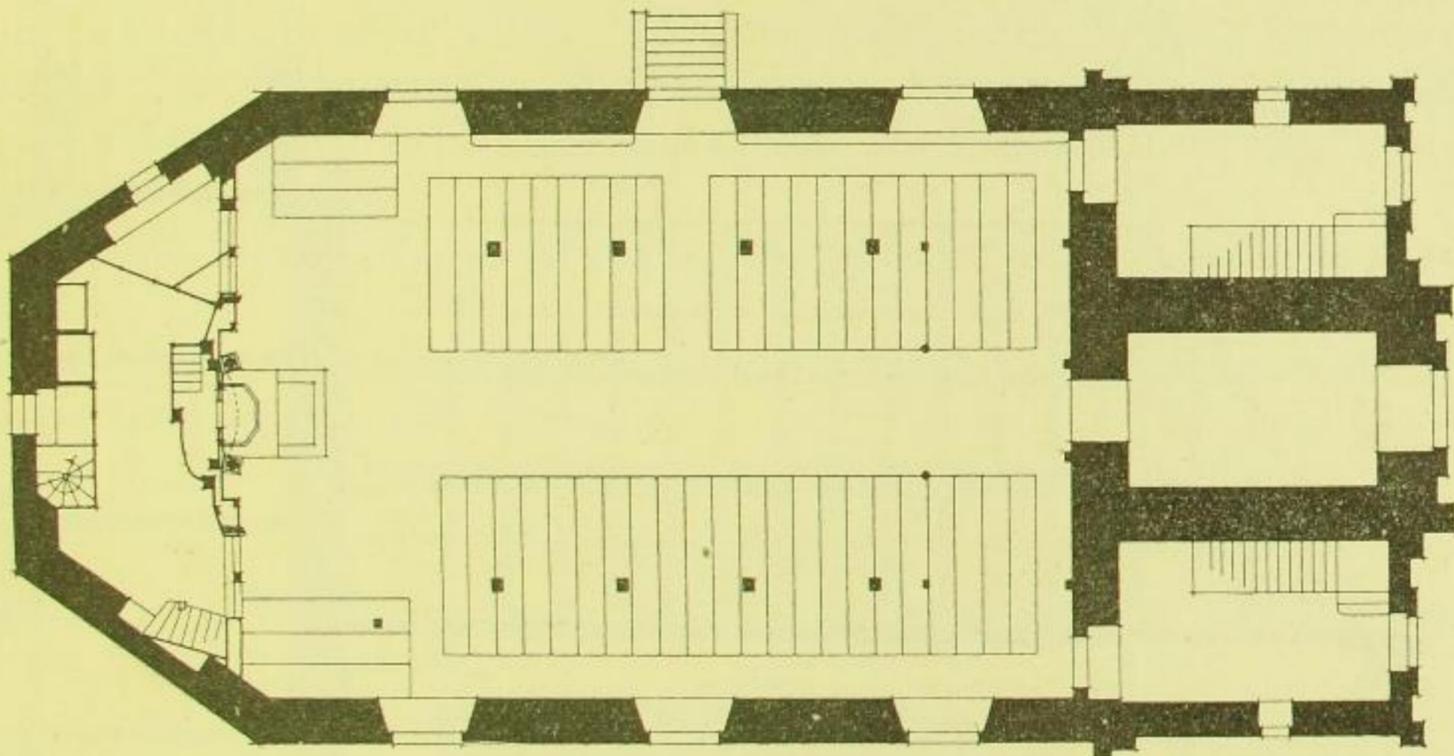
Wehrsdorf, Kirche, Grundriß.
